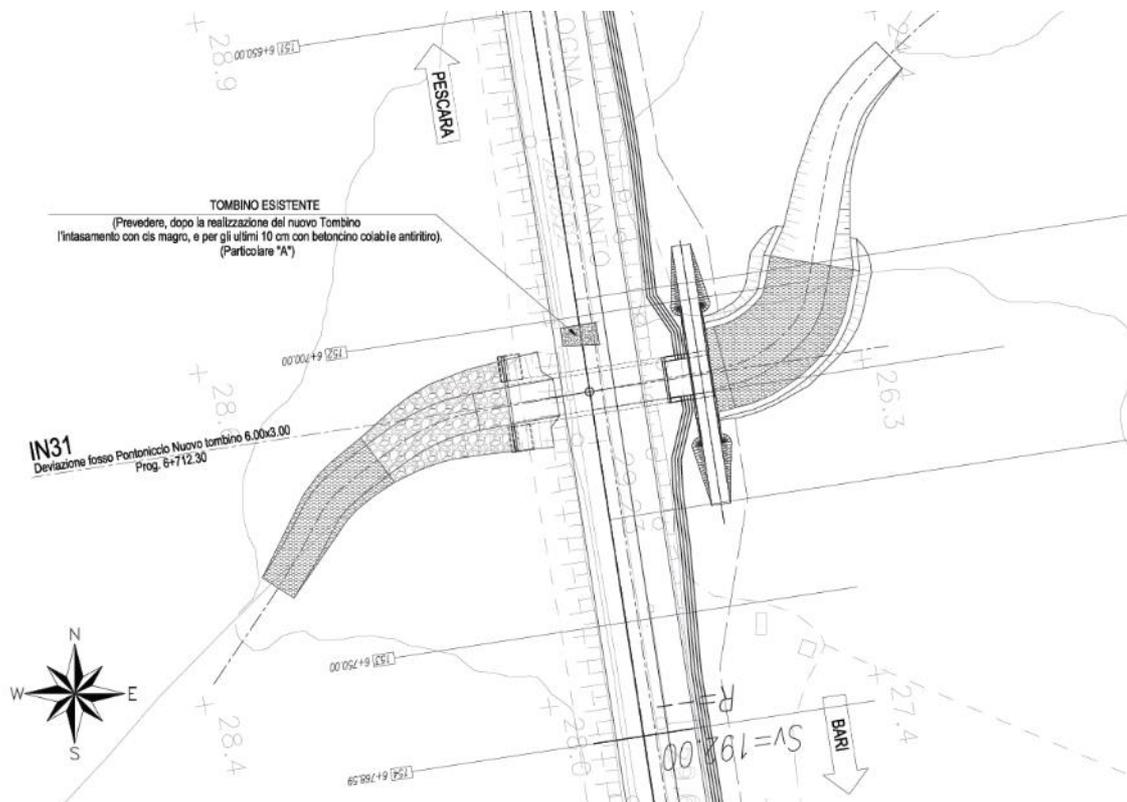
Adeguamento idraulico Fosso Pontonicchio – Vista Planimetrica
